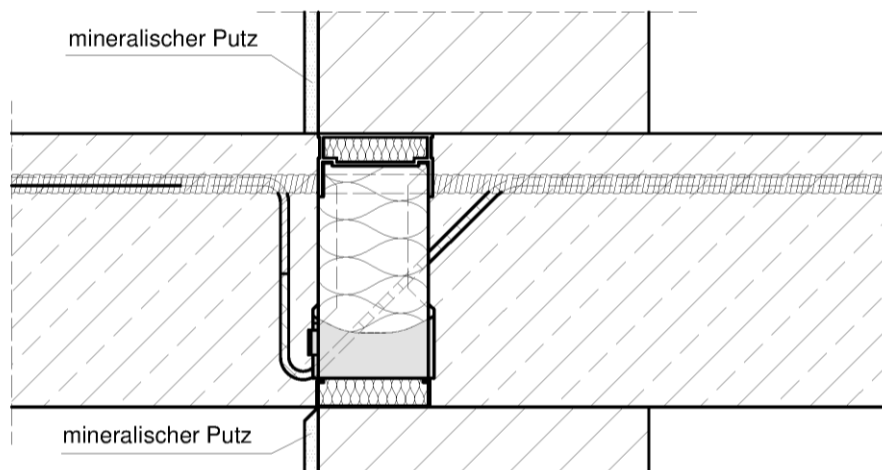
Schöck Isokorb® (REI30) gem. Abschnitt 3.2.2
